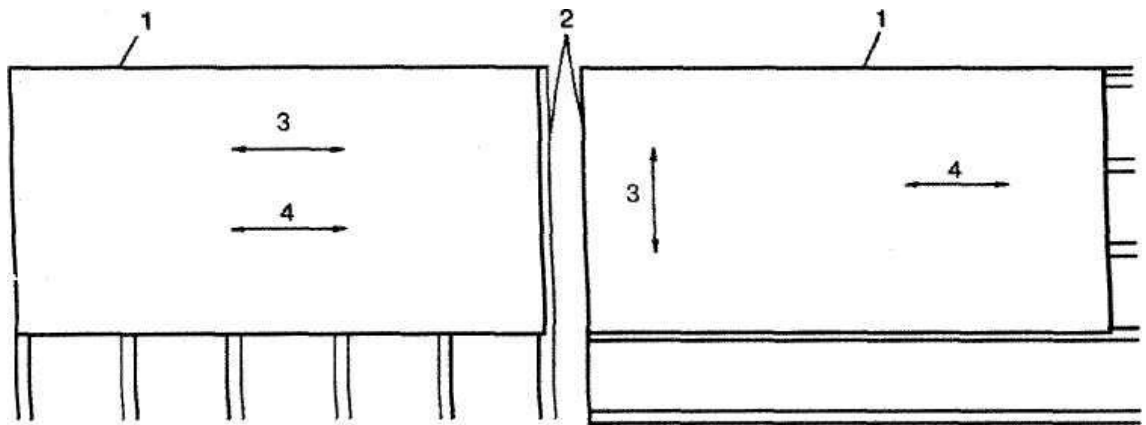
Поперечне (а) і поздовжнє (б) кріплення ГКП до каркасу:
